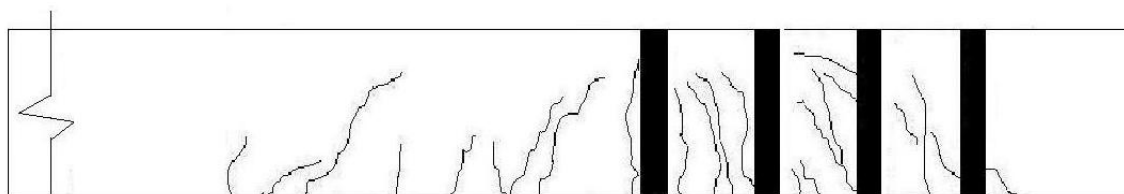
Panorama de fissuração da Viga V31.
